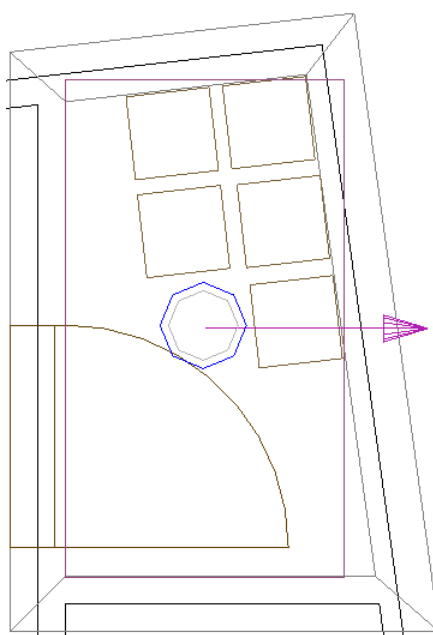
Plano del área de baterías de la vivienda unifamiliar.
